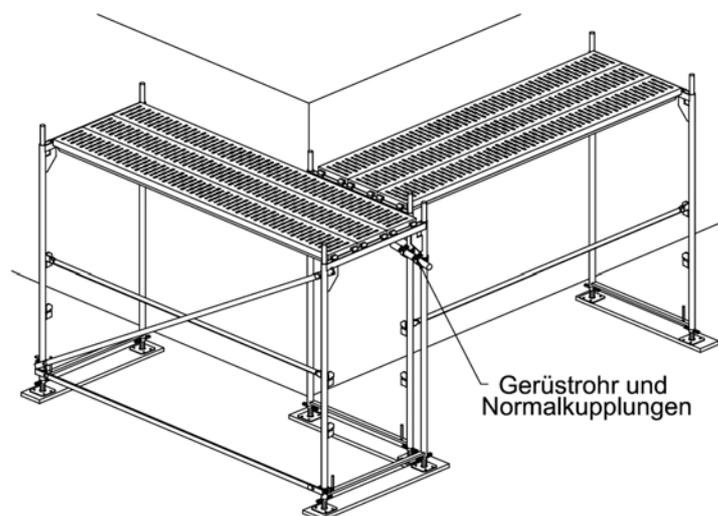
Eckausbildung mit Gerüstrohren und Normkupplungen (Gerüst nur teilweise dargestellt)
